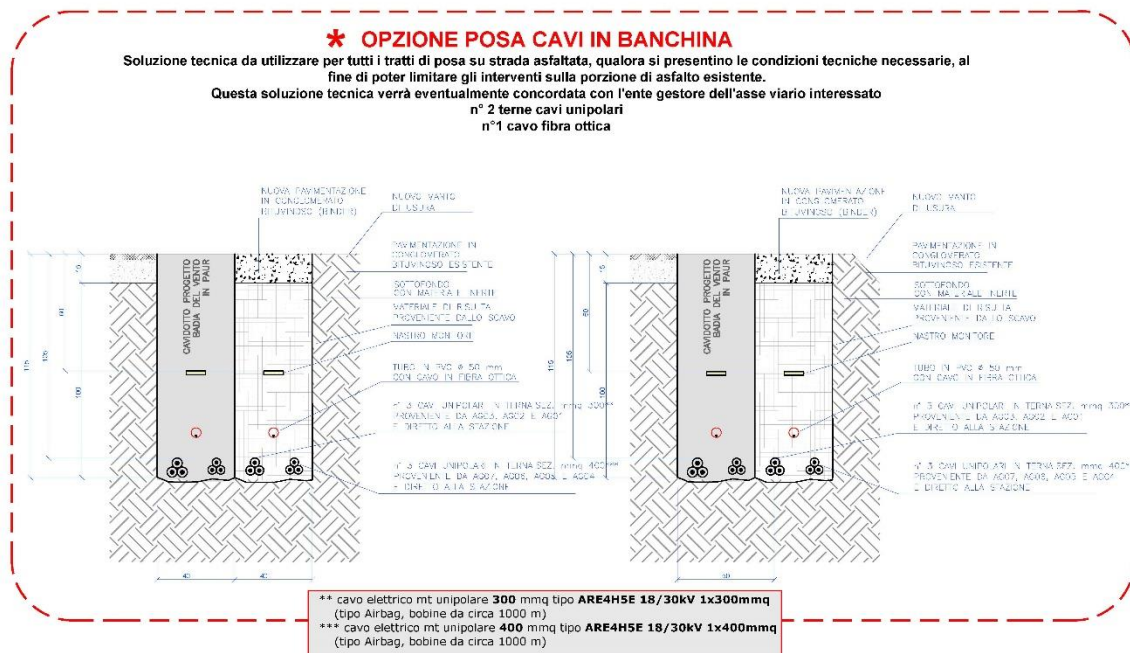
Estratto elaborato PSS-4.17\_Cavidotto-Planimetria Linea Elettrica su CTR - Pianta e Sezioni, soluzione di posa delle due terne di cavi unipolari su banchina, lato strada
